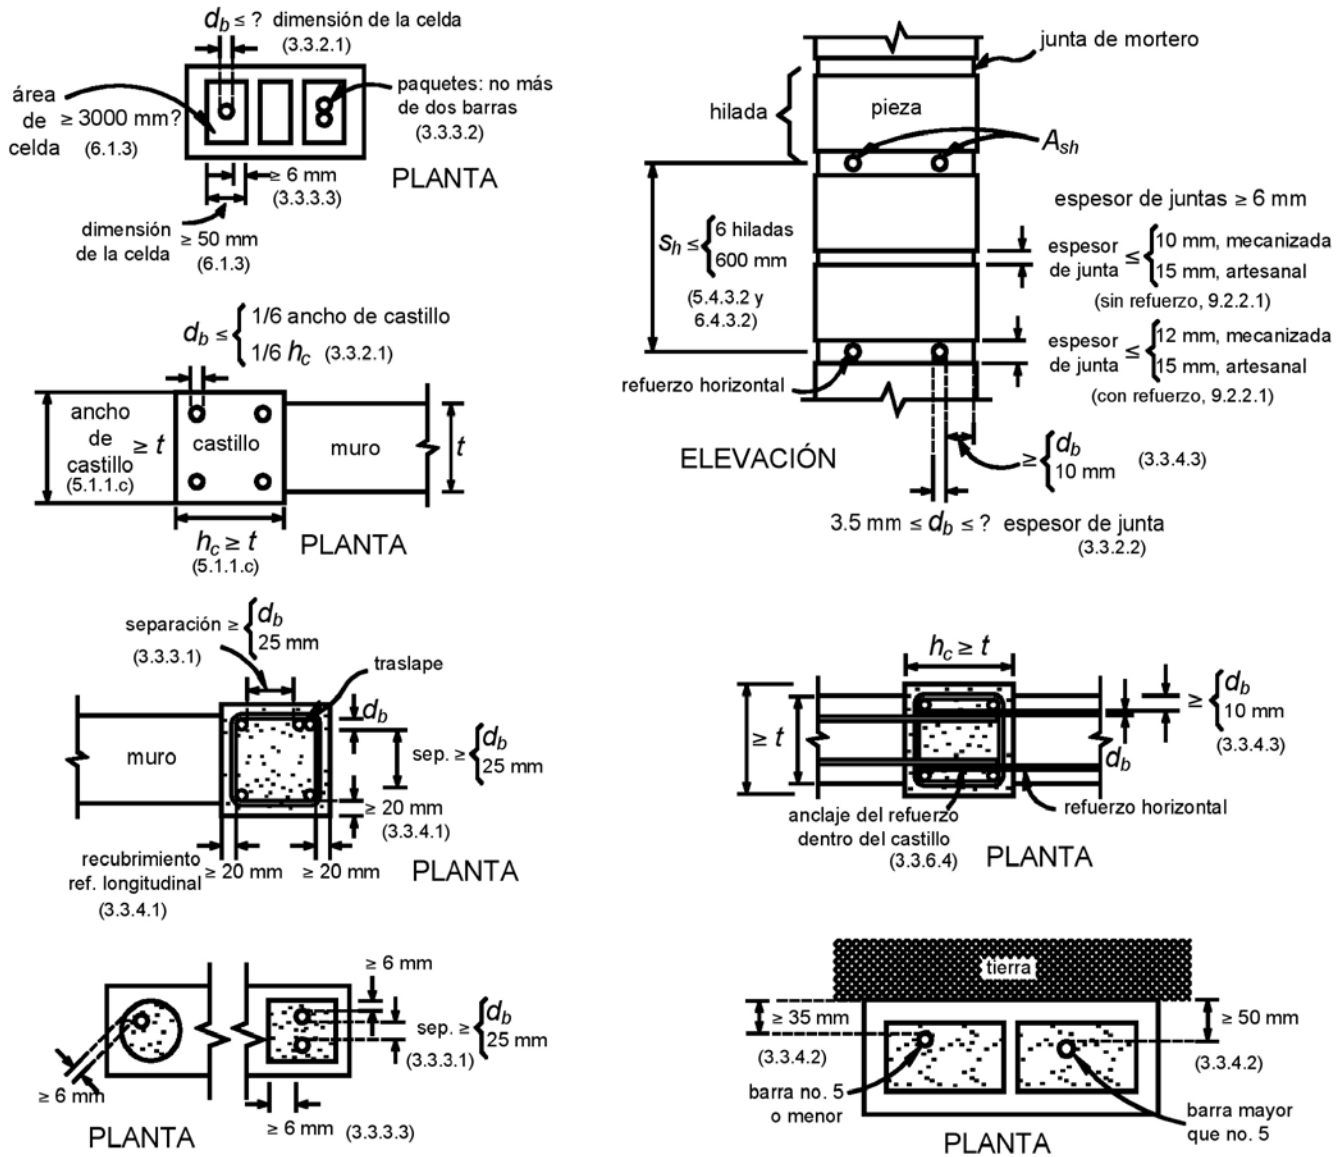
Tamaño, colocación y protección del refuerzo
